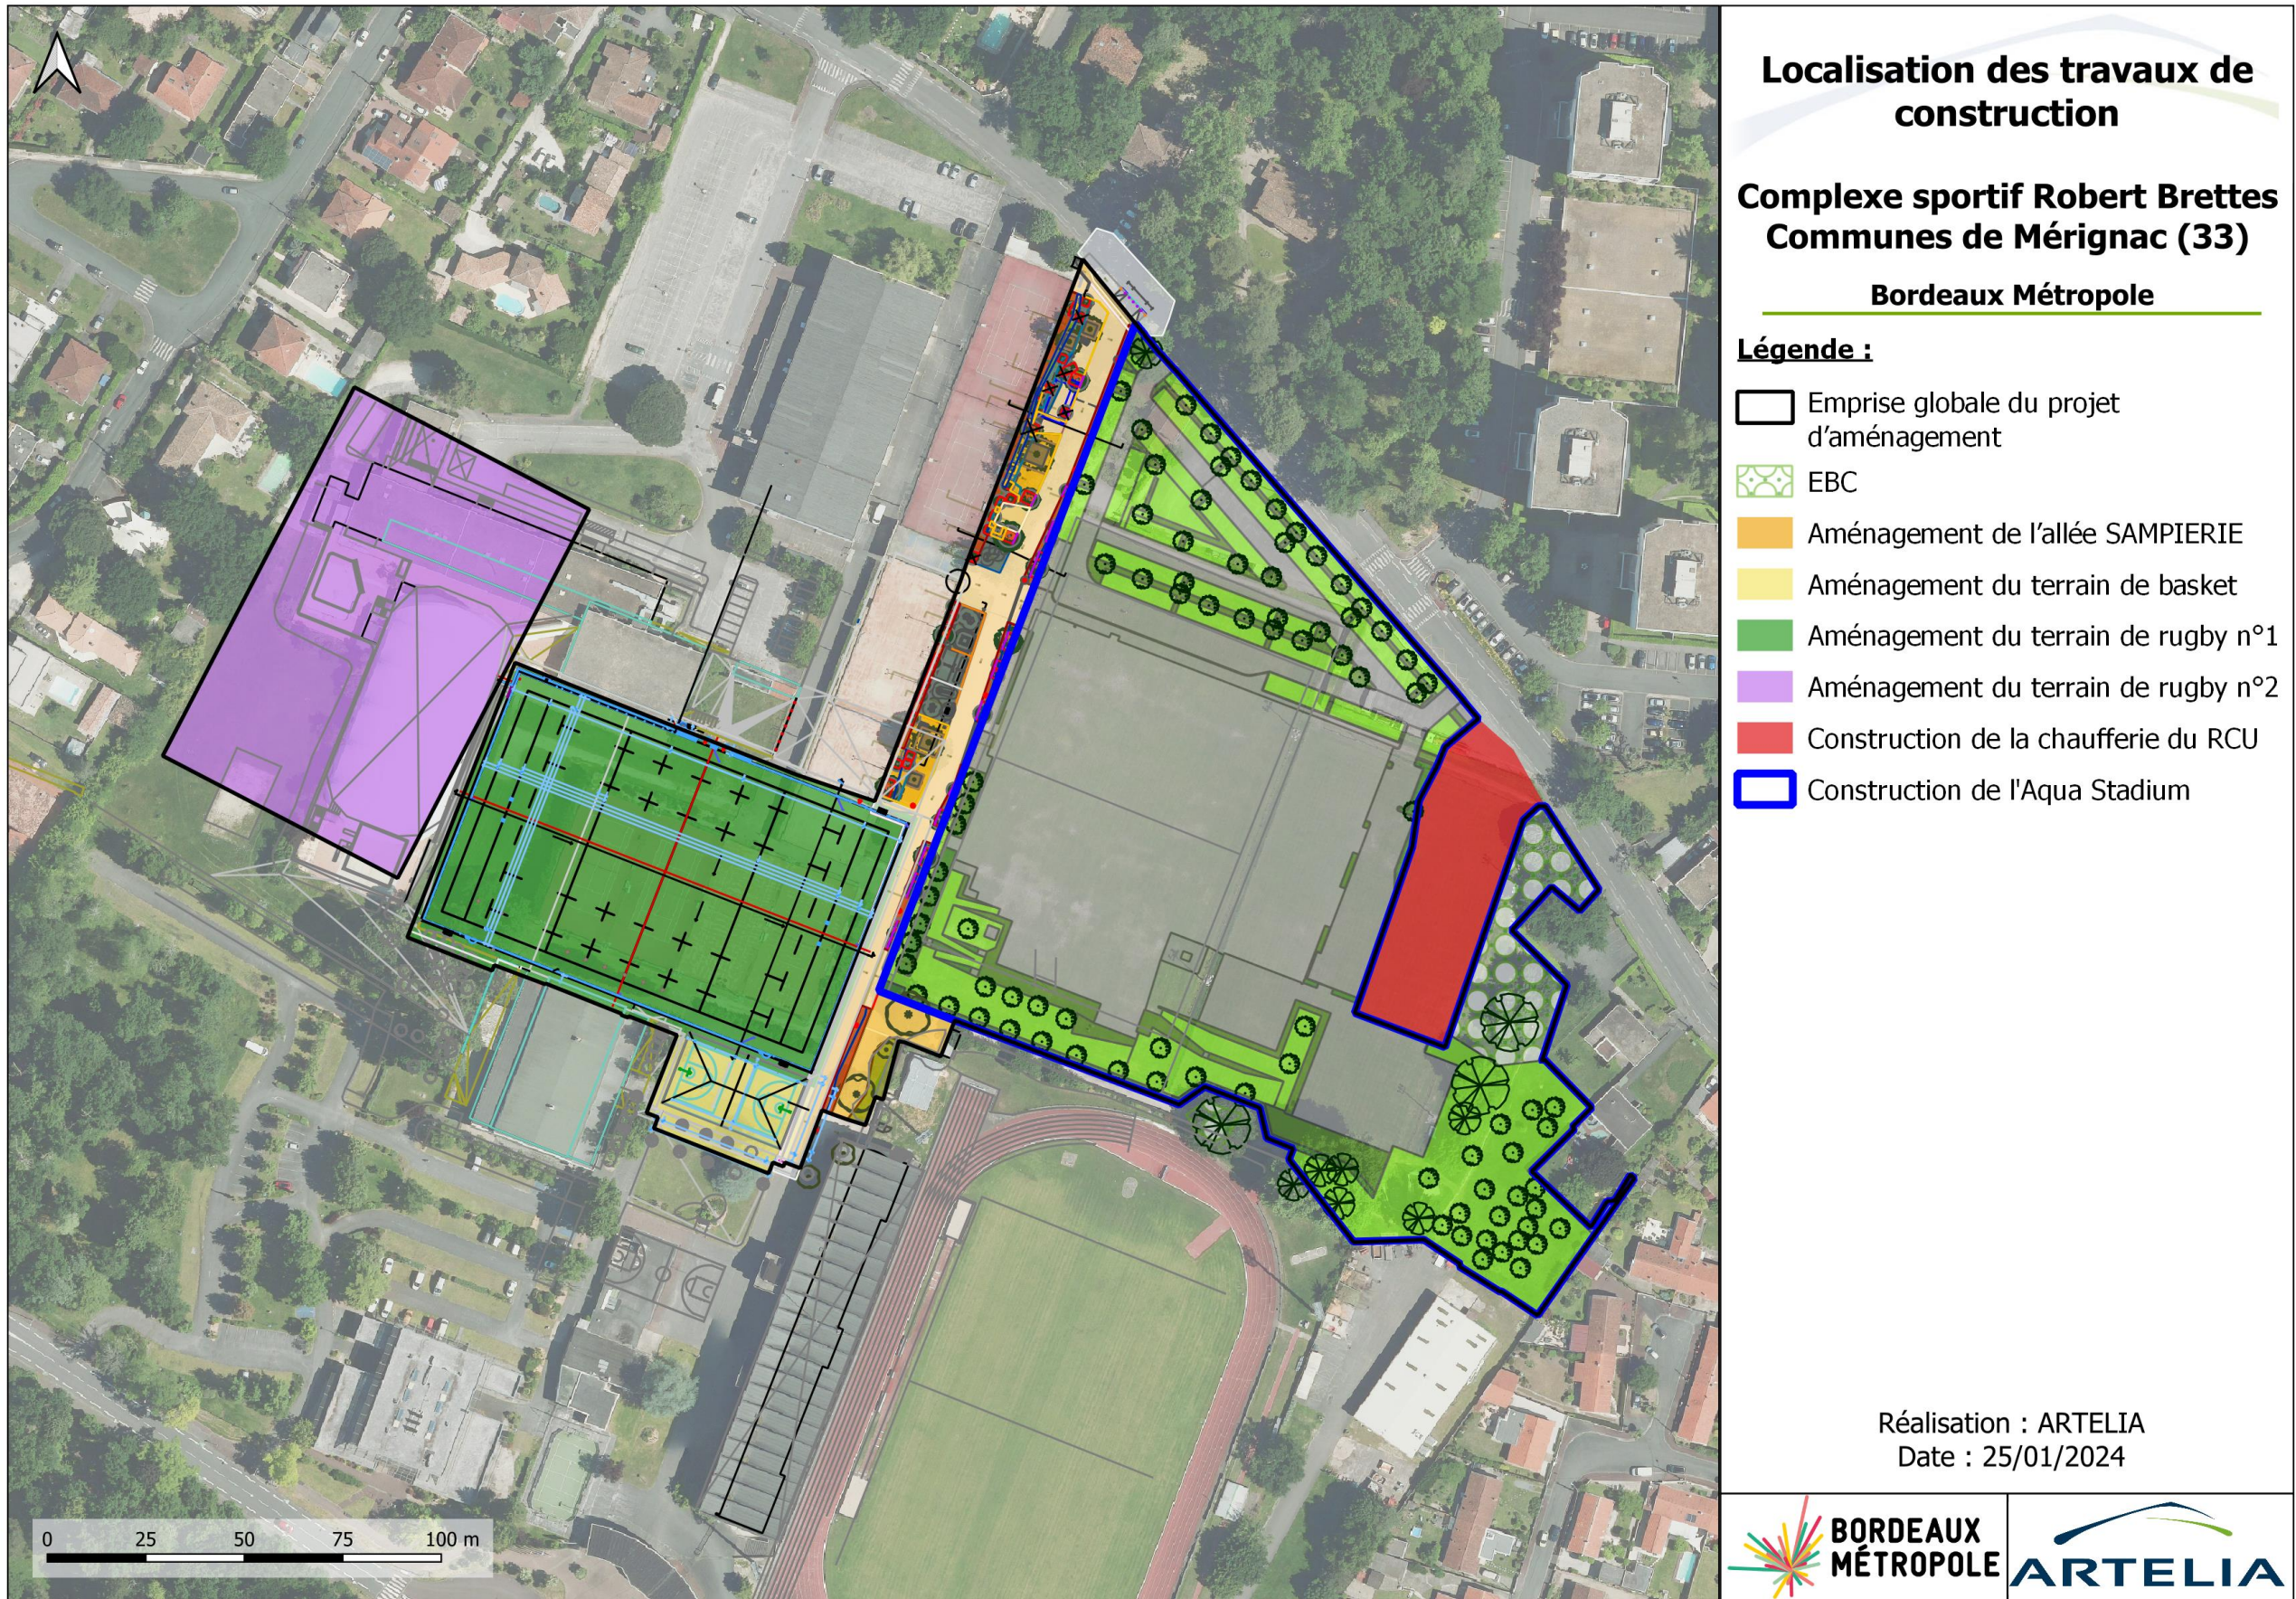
Travaux de construction prévus au sein du complexe sportif Robert Brettes
